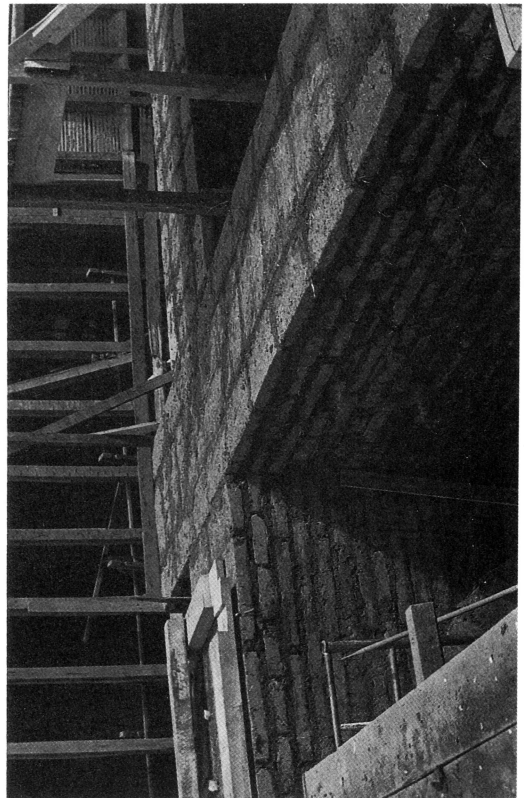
Detalle del proceso constructivo de los muros de adobe.
